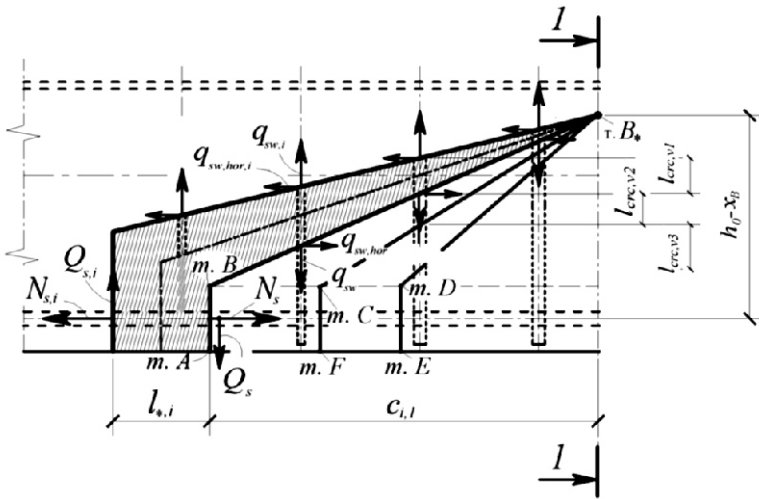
Расчетная модель для определения усилий в продольной и поперечной арматуре в трещинах, образующих веер 1, прилегающий к сосредоточенной силе
